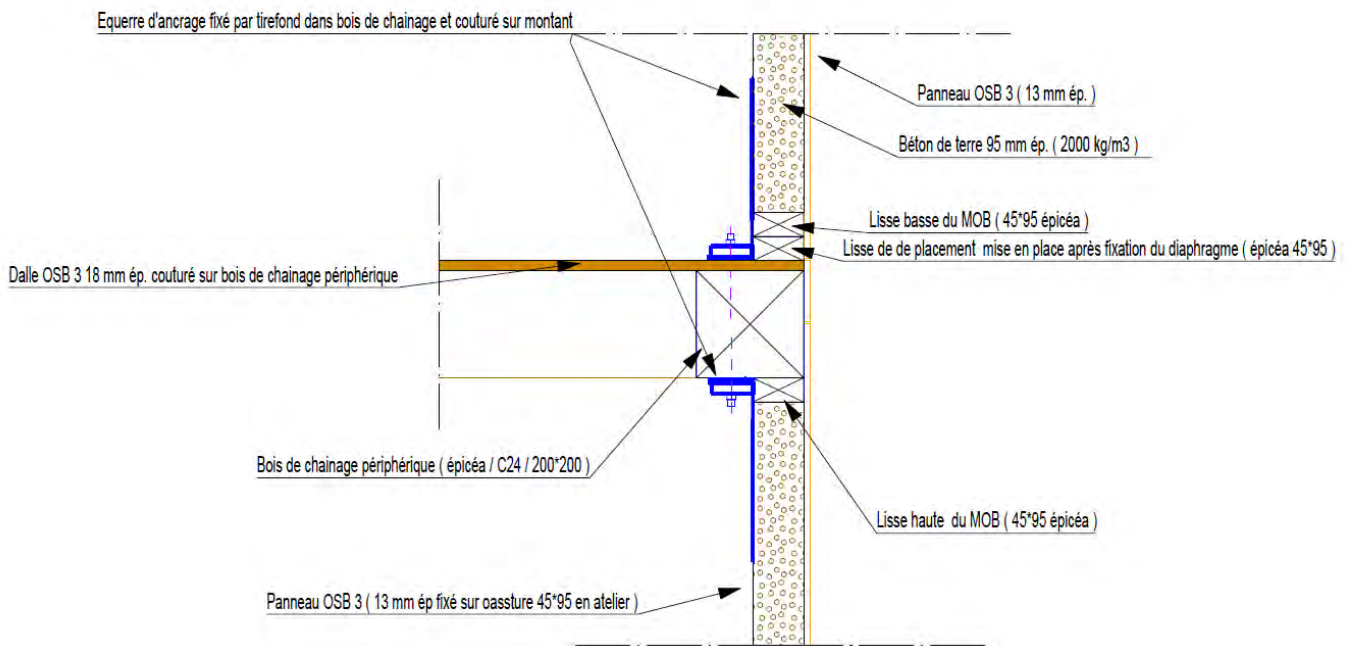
COB – Coupes de principe liaison plancher bois / Mur ossature bois et continuité des tirants – CVT 1 face (extérieur)
